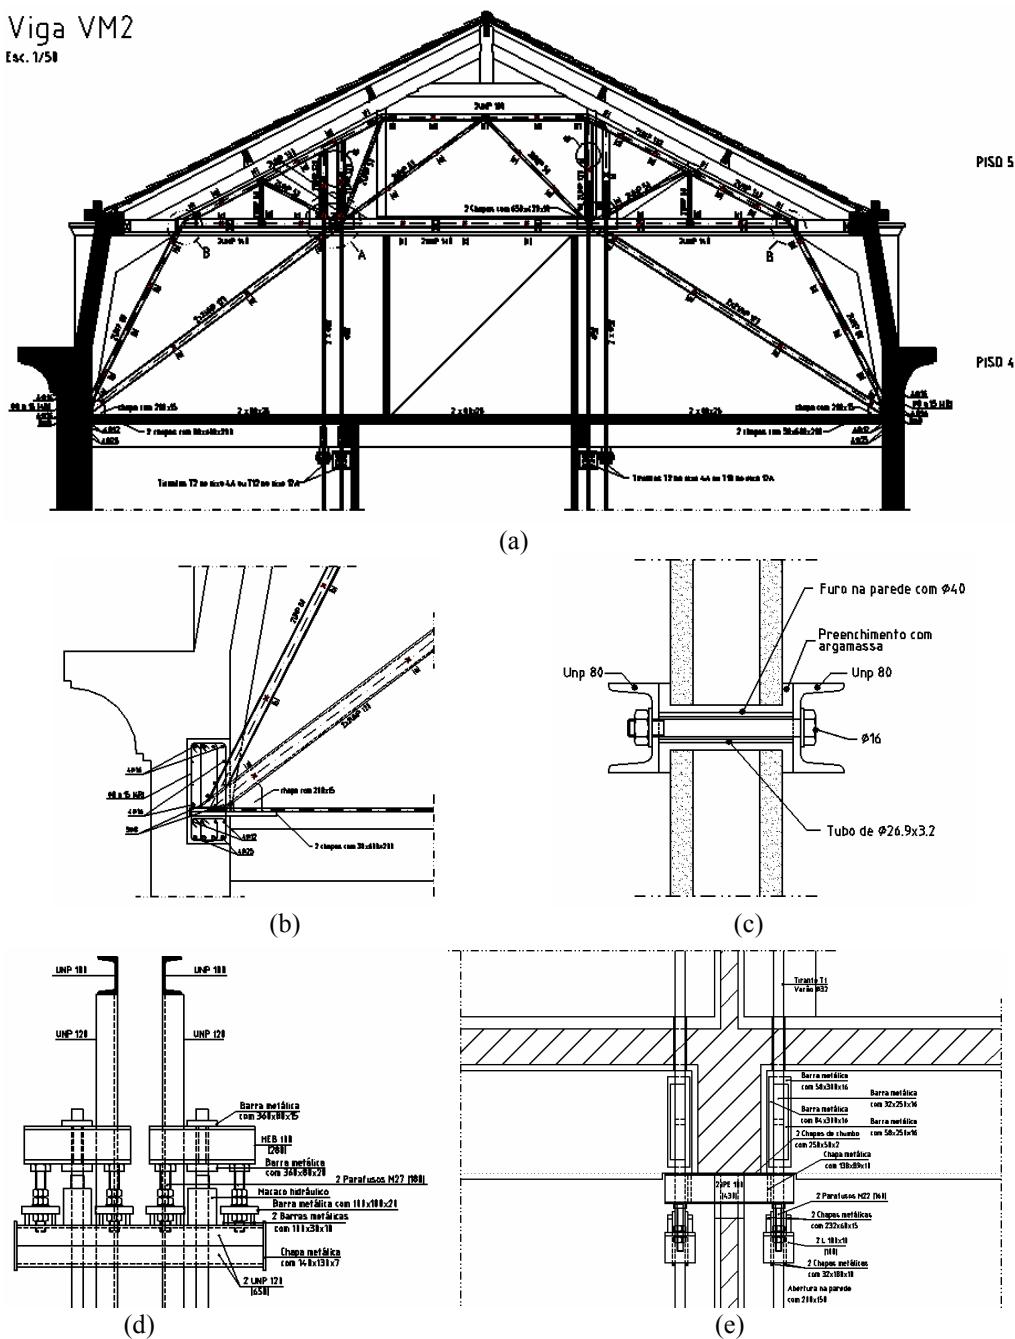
Detalhes do projecto de execução: (a) viga-metálica tipo na cobertura; (b) apoio da viga-metálica nas paredes de contorno em cantaria de granito; (c) diagonais que envolvem as paredes transversais de granito; (d) macacos para colocação do sistema de reforço em carga; (e) detalhes de apoio das vigas principais dos pisos
